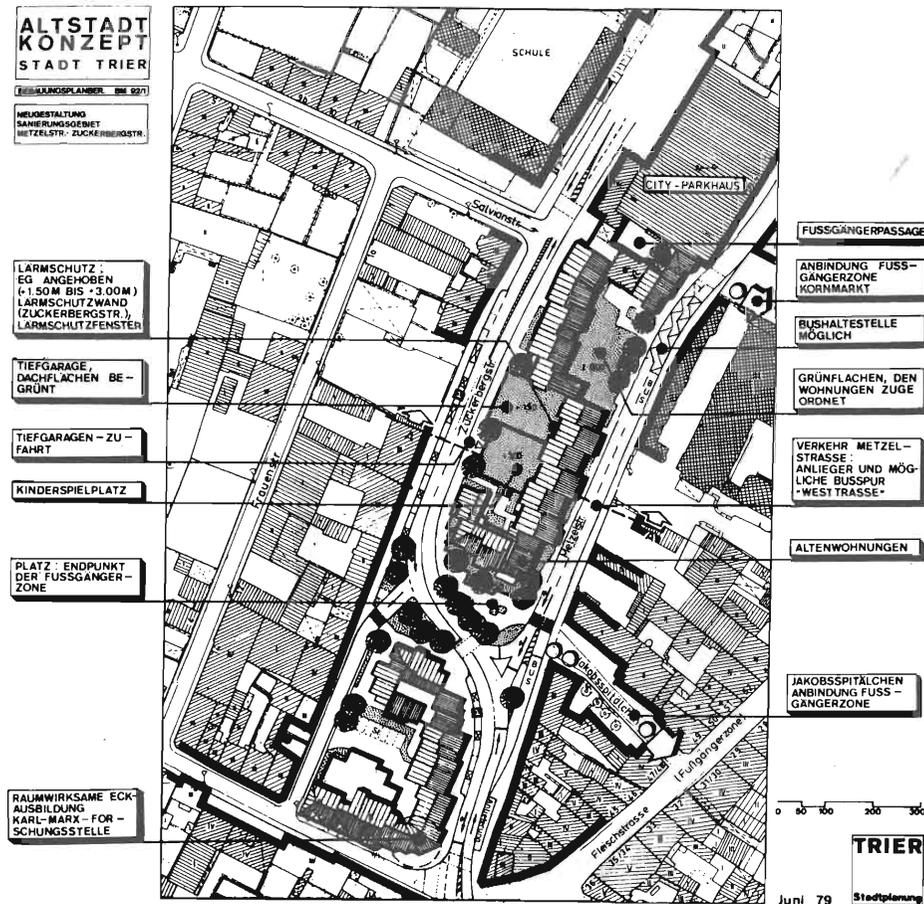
Sanierungsgebiet Zuckerberg-/Metzelstraße, Lageplan.
